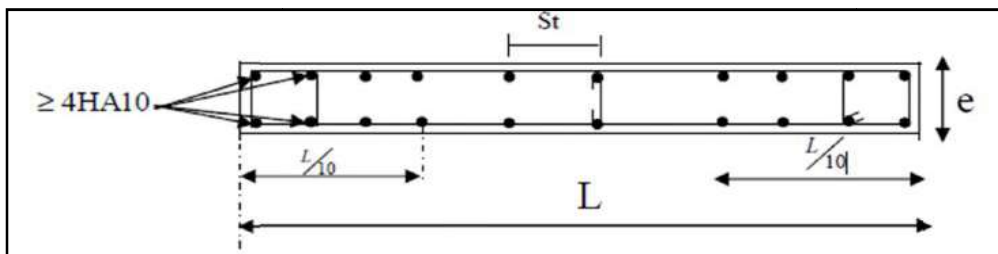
Disposition des armatures verticales dans les voiles.
